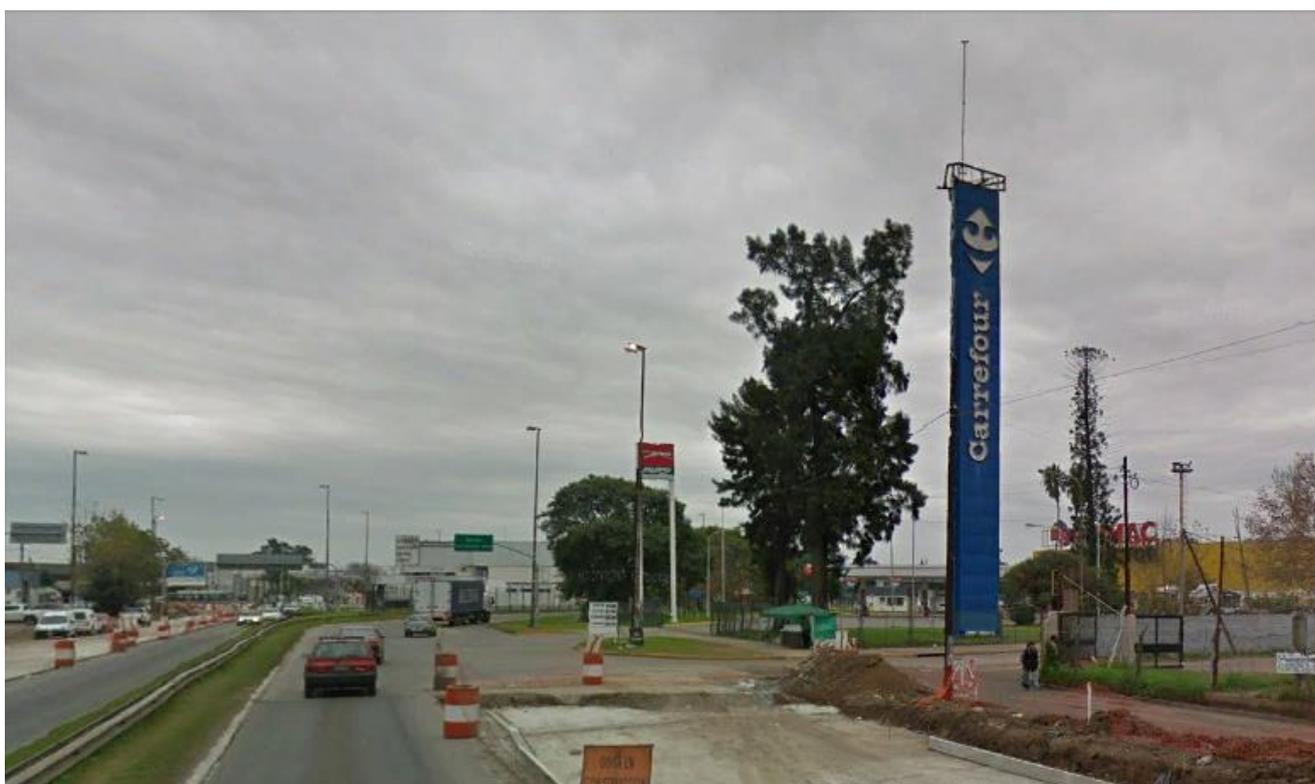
Vista de Supermercado Carrefour sobre intersección de la Ruta Provincial N° 4 y la Calle Guido y Spano.
